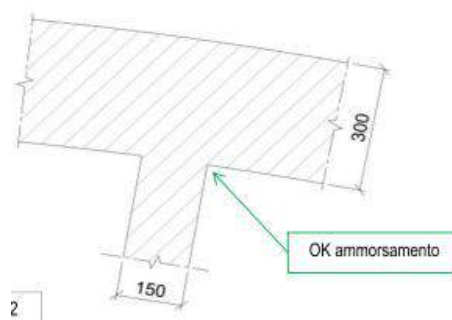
Piano terra dei palchi: Muro di spina tra palchi e corridoio (saggio T5)
